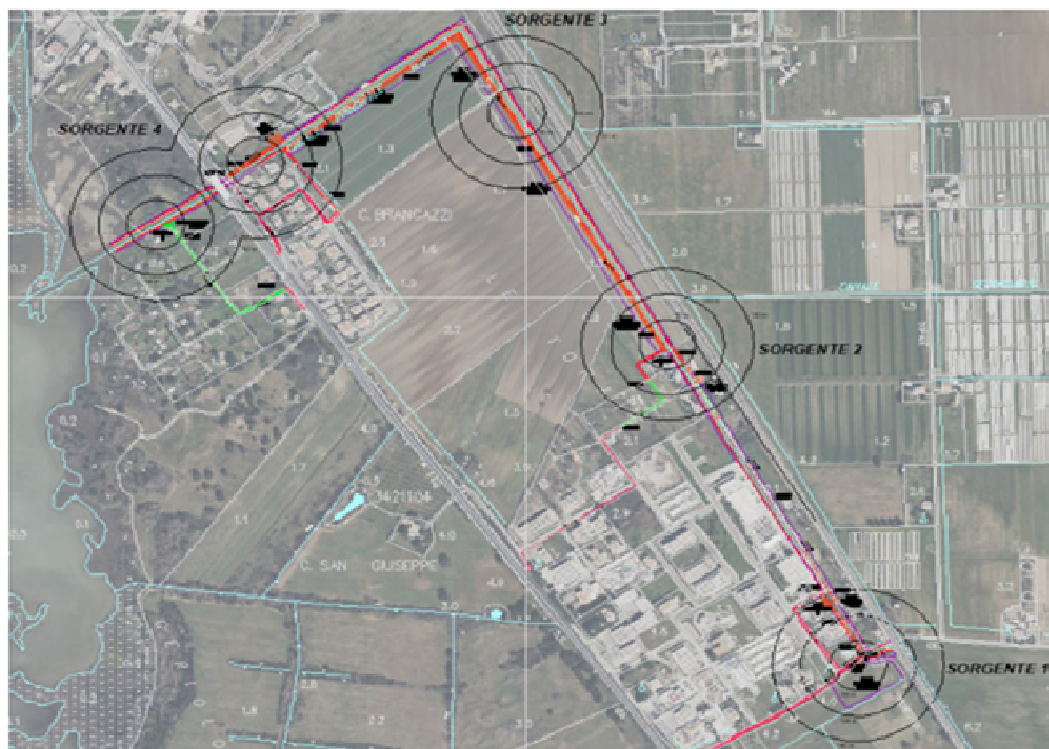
estratto di tavola PGO\_01 - planimetria della cantierizzazione
